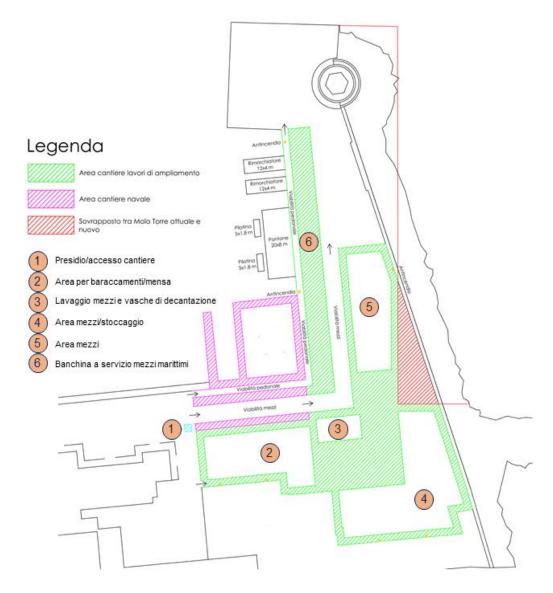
Schema area di cantiere ipotizzata all'estremità dell'attuale diga di sopraflutto.
